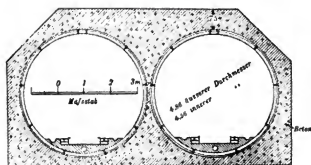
Querschnitt durch den Tunnel unter dem Harlemflusse.
